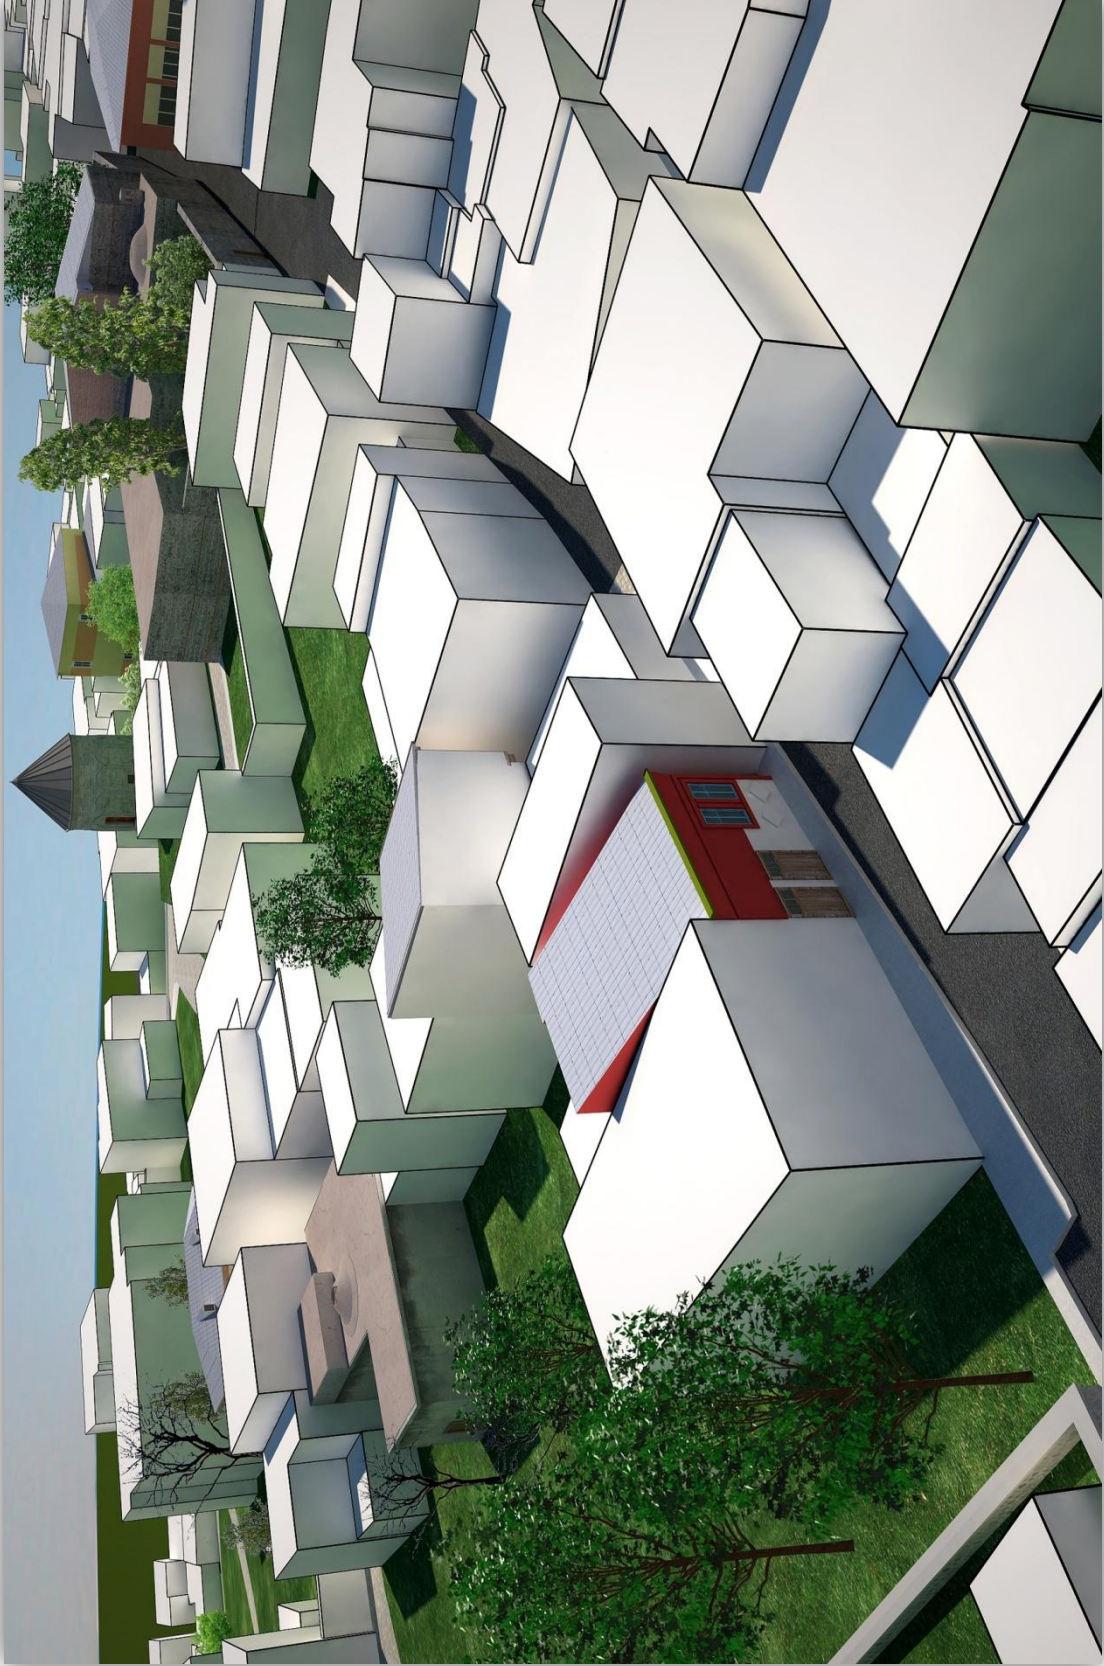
Ankette sunulan 12 nolu örneğin vaziyet planı
